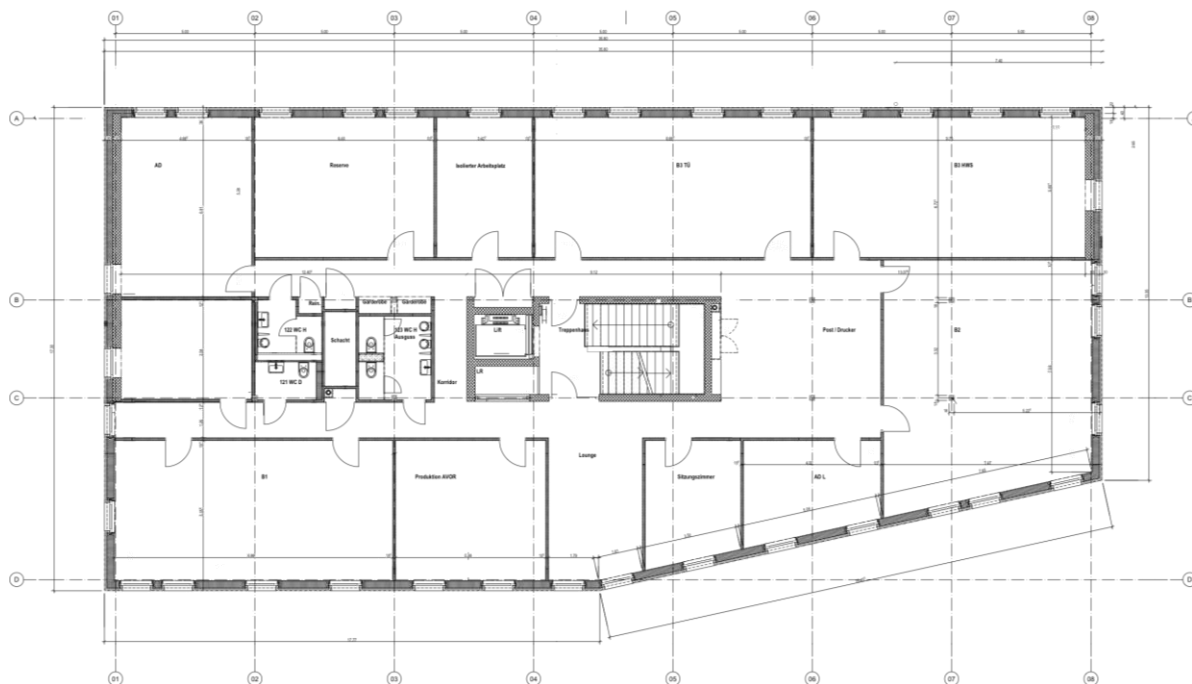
Grundriss 1. Obergeschoss Neubau Büro- und Ausstellungsgebäude OLWO, nicht massstäblich
